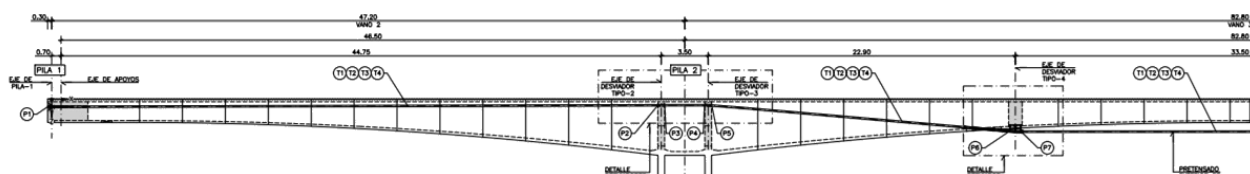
Semi-alzado longitudinal del trazado del pretensado exterior de refuerzo
